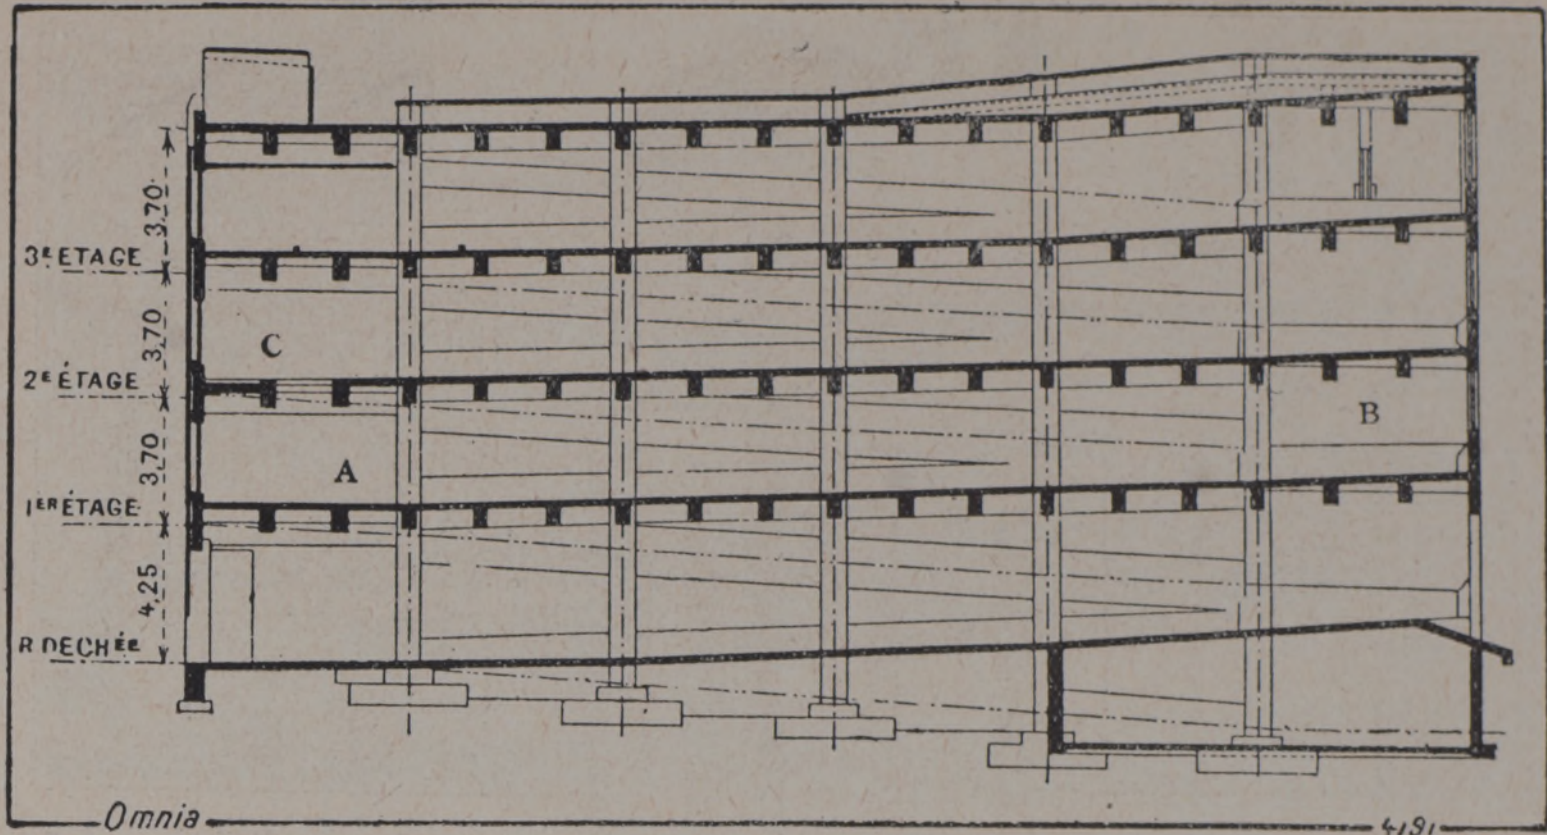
Fig. III. — Coupe du Fort Shelby Garage. — On se rend compte très aisément de la disposition de la rampe qui s'élève dans la longueur du bâtiment, de la hauteur d'un demi-étage (de A en B). On aperçoit en pointillé la deuxième partie de la rampe qui conduit à l'étage supérieur (de B en C).
